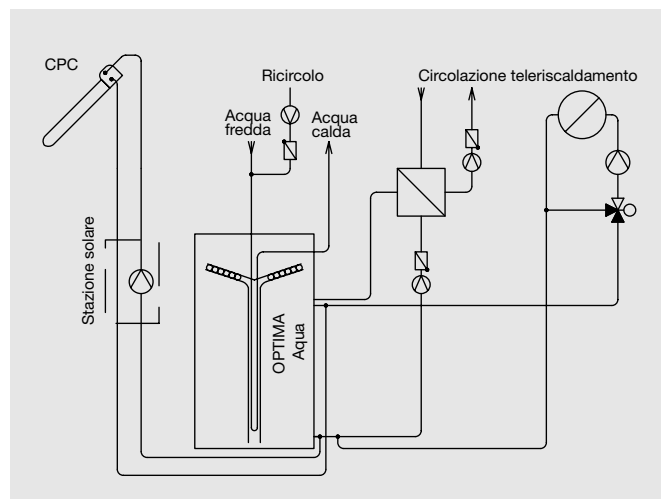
Impianto idraulico con collegamento a teleriscaldamento
